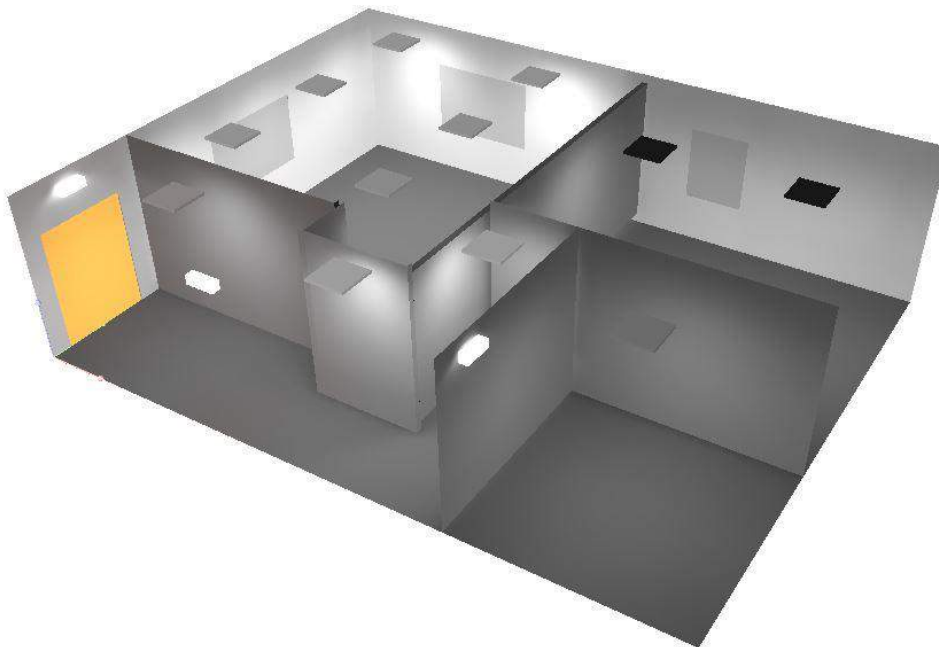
Vista 3D de la iluminación en la Planta Alta
